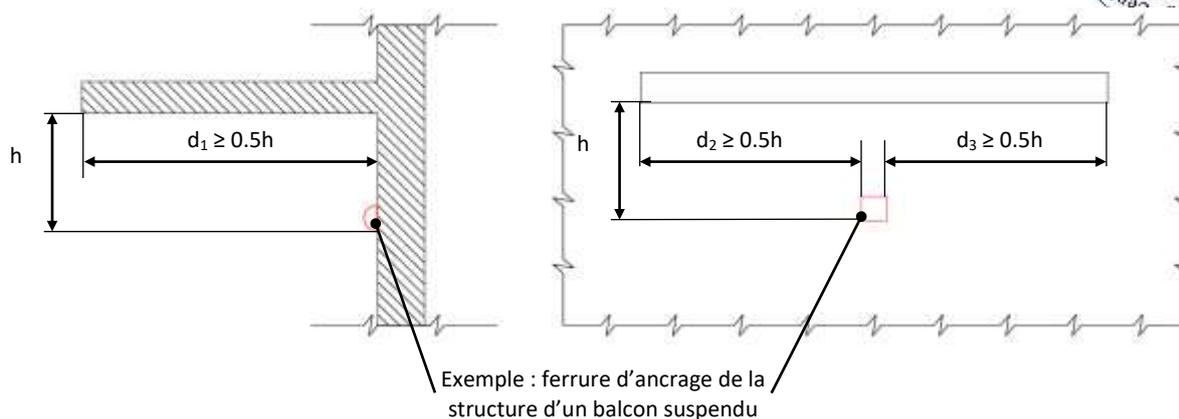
Représentation des critères de protection des traversées ponctuelles de l'ETICS par une ferrure d'assemblage ou poutre
